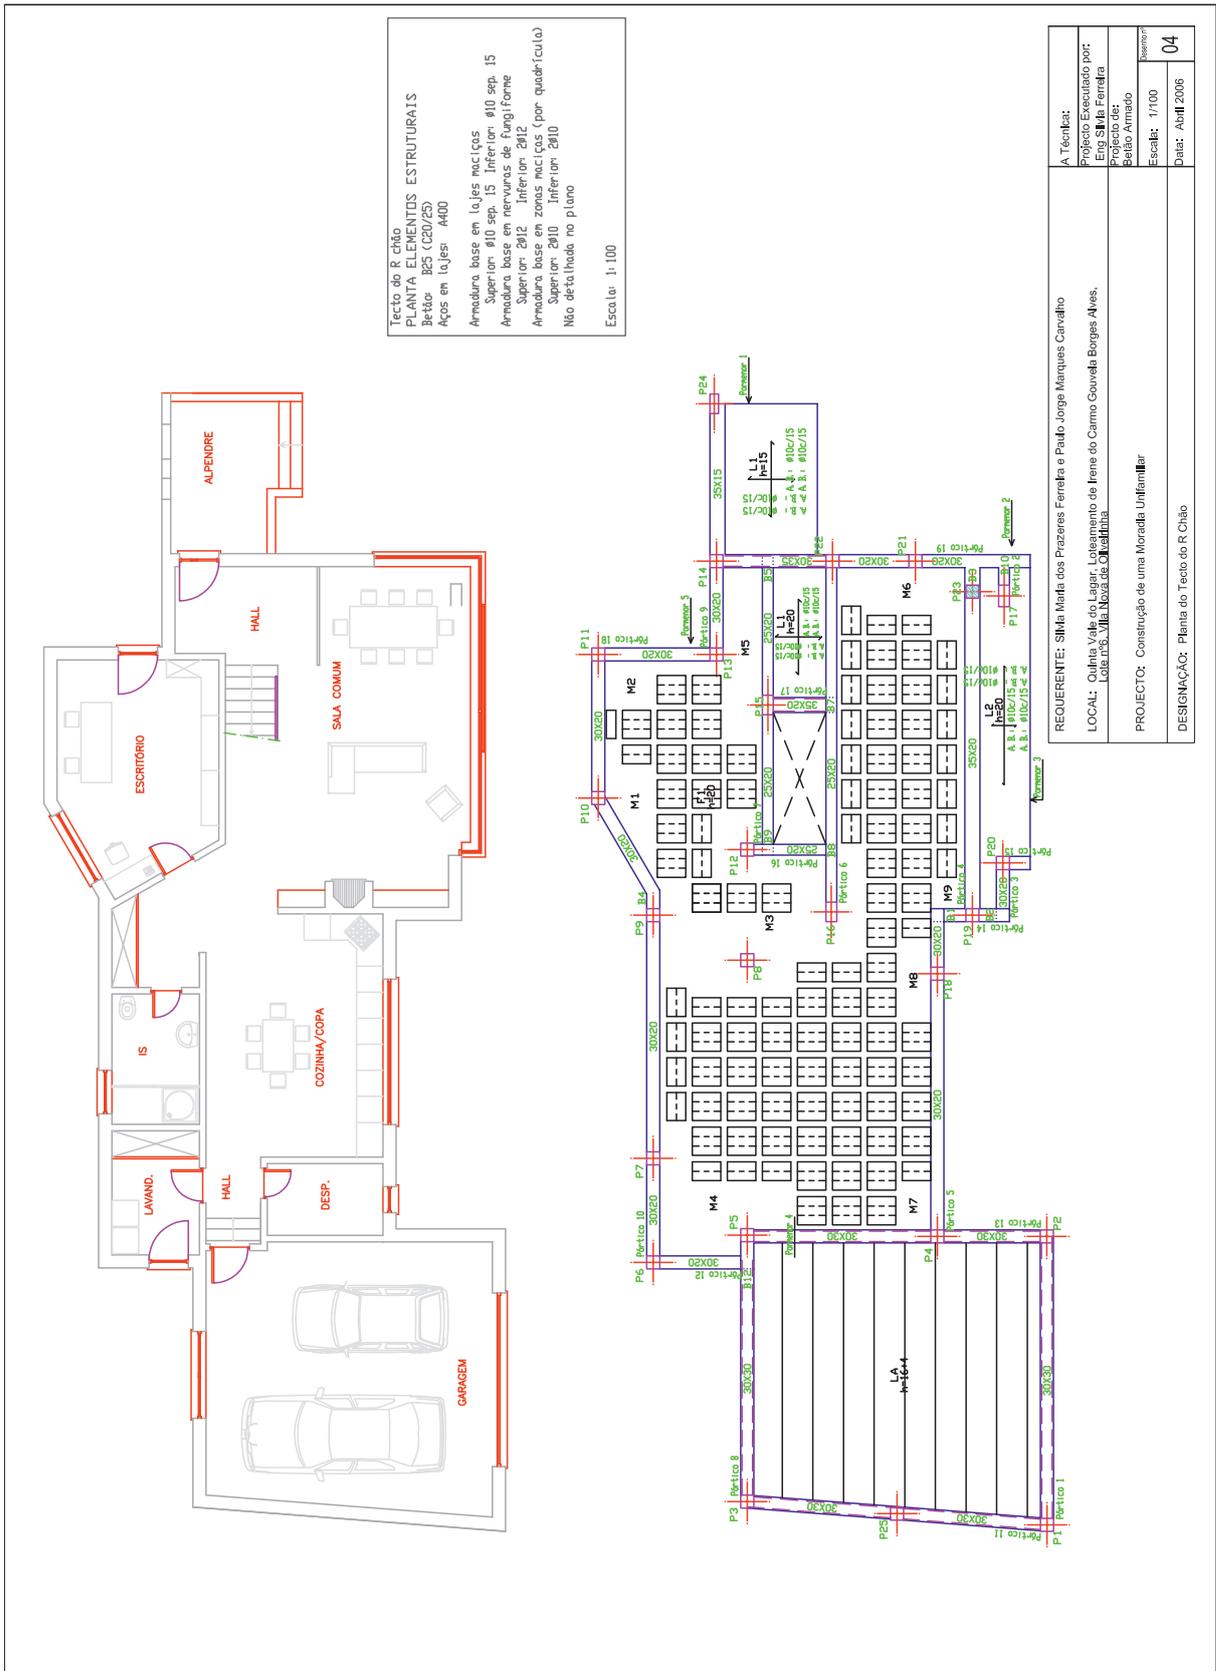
Planta de arquitetura/estrutural do Rés-do-chão da solução em BA
